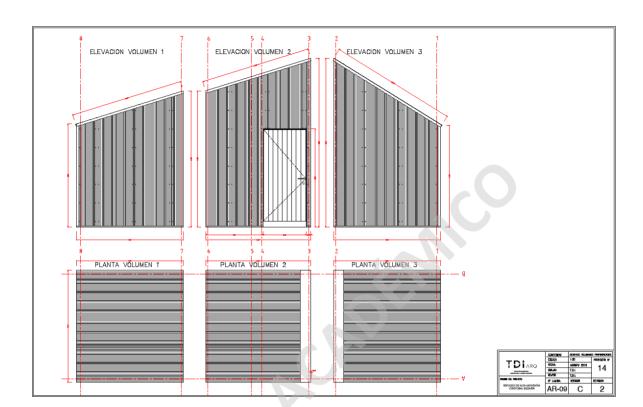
Elevación y en planta en general, elevación oriente y poniente.
